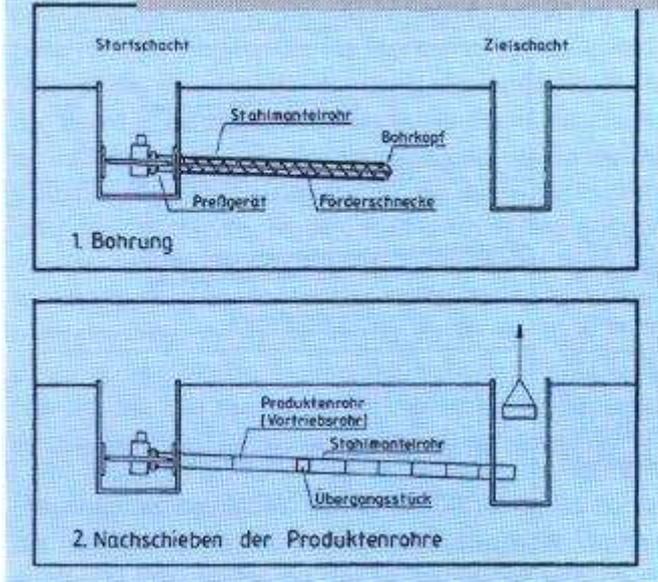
Nicht steuerbares Horizontal-Preßbohrgerät
